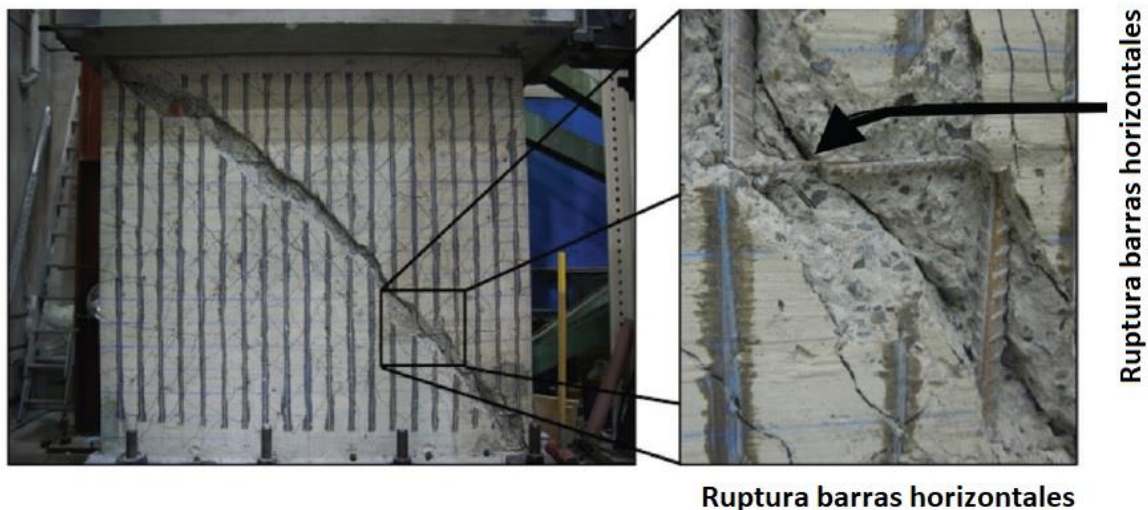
Falla por Tracción Diagonal (Arafa et al. 2021)
